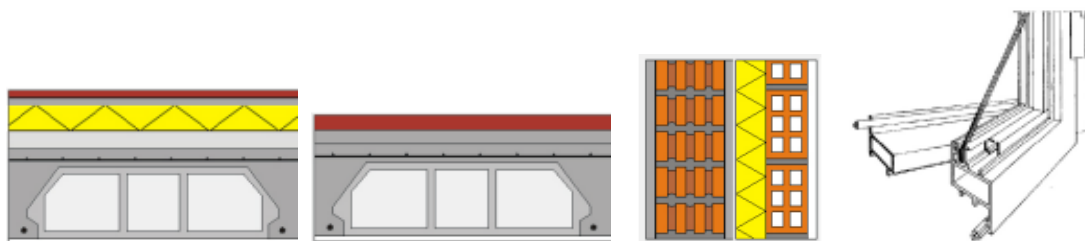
Detalles constructivos Cubierta, Fachada, Carpintería, Forjado. Fuente TABULA [108].
